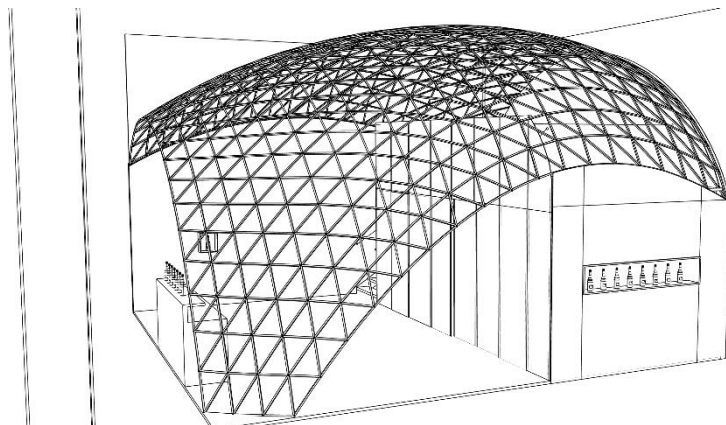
proposta progettuale dell'architetto M. Giannetti
